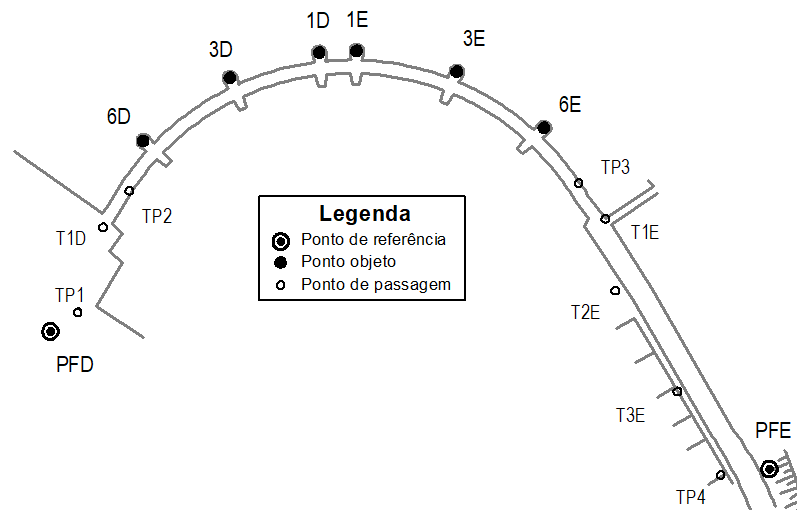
Planta da linha de nivelamento no coroamento da barragem da Bemposta.
